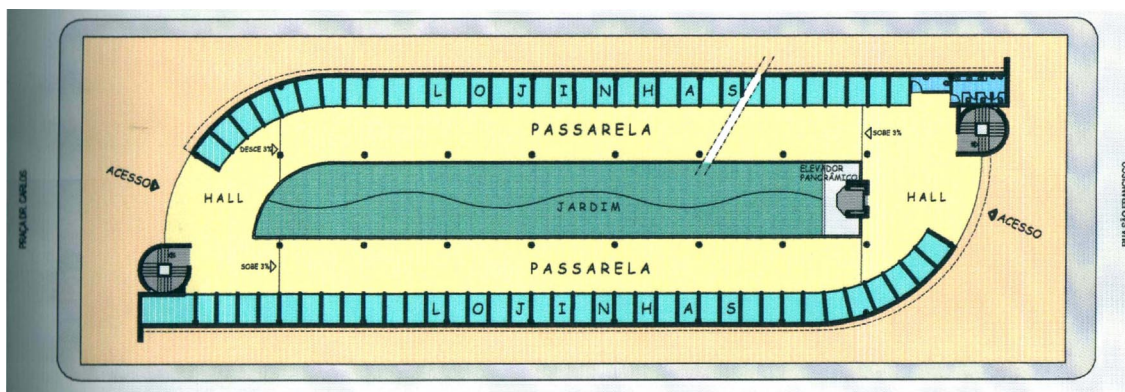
Planta do primeiro pavimento - térreo
